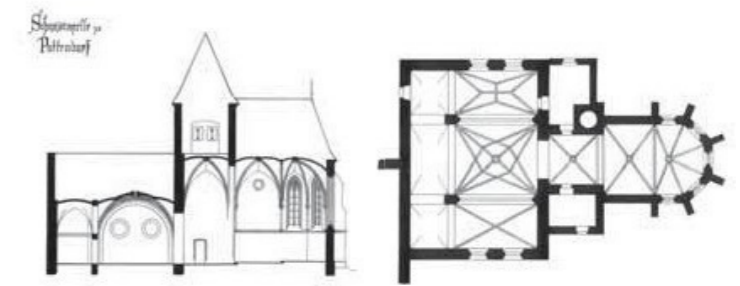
Schloss Kapelle, Schnitt und Grundriss
